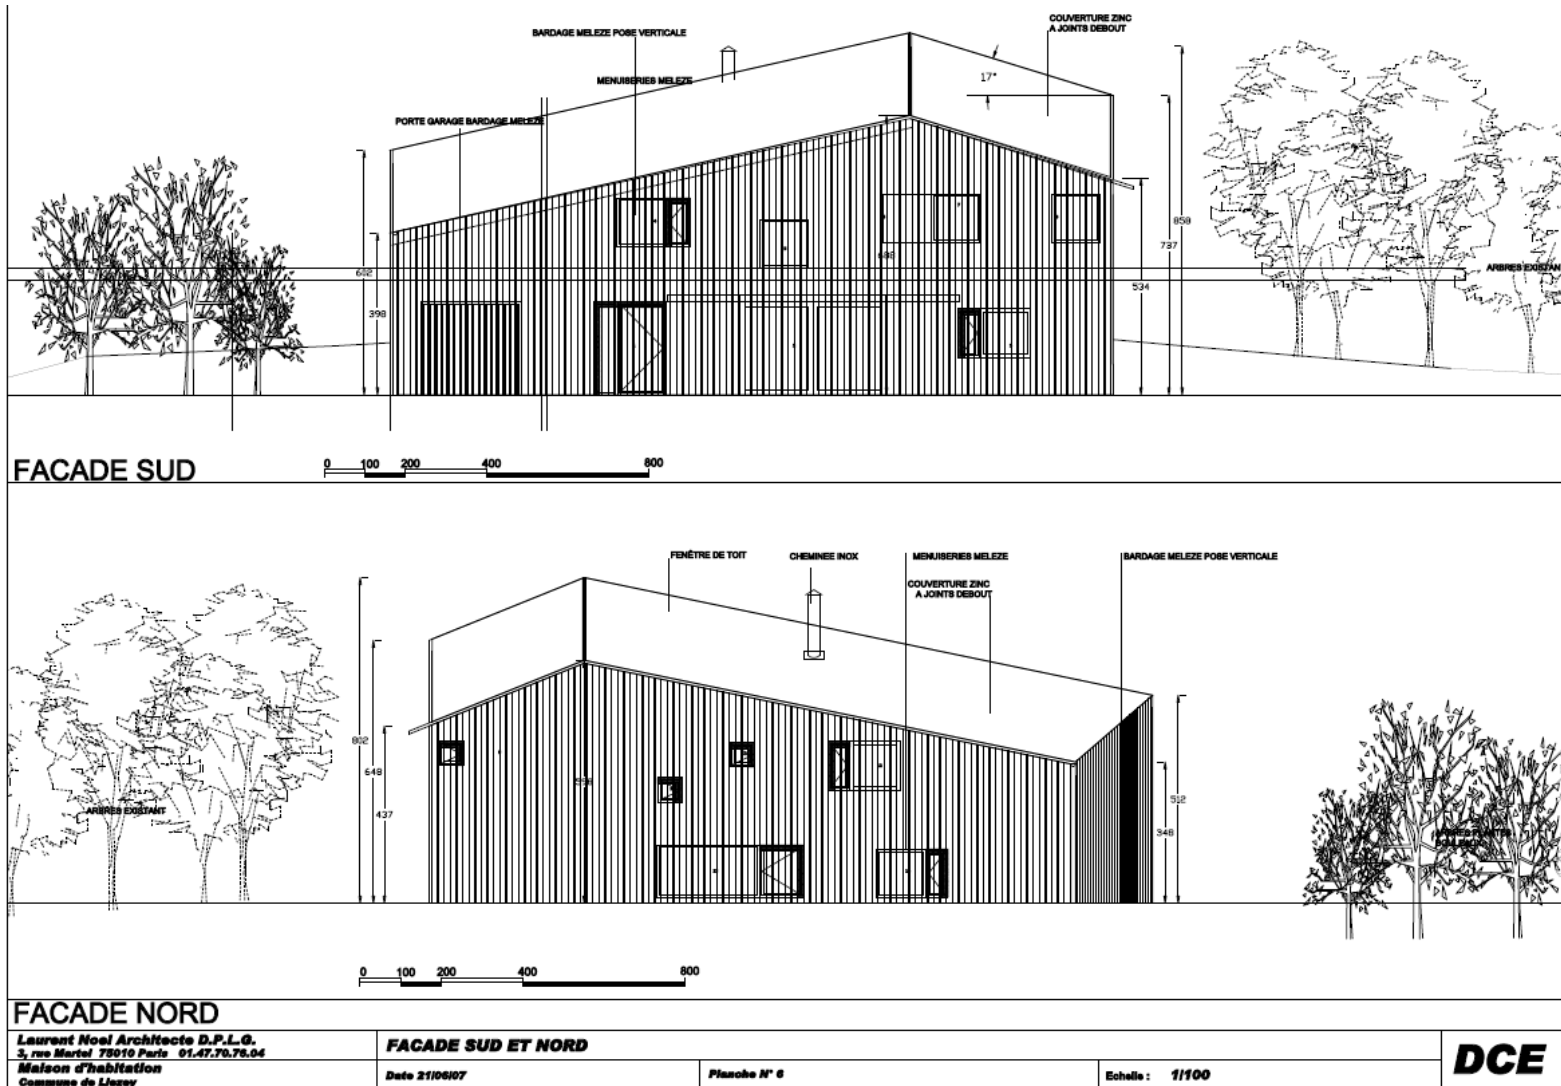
Maison en panneaux contrecollés massifs : coupe d'une façade
